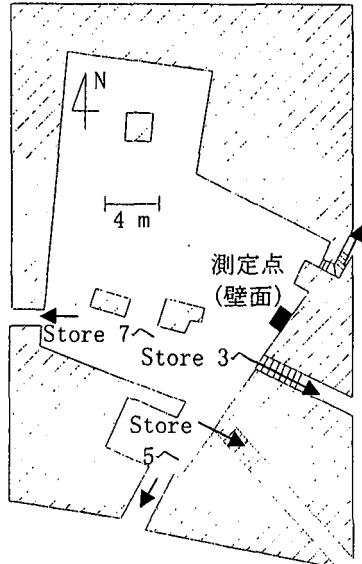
地下商店（Store 5）の平面図. 天井高さ 2.5 m.
